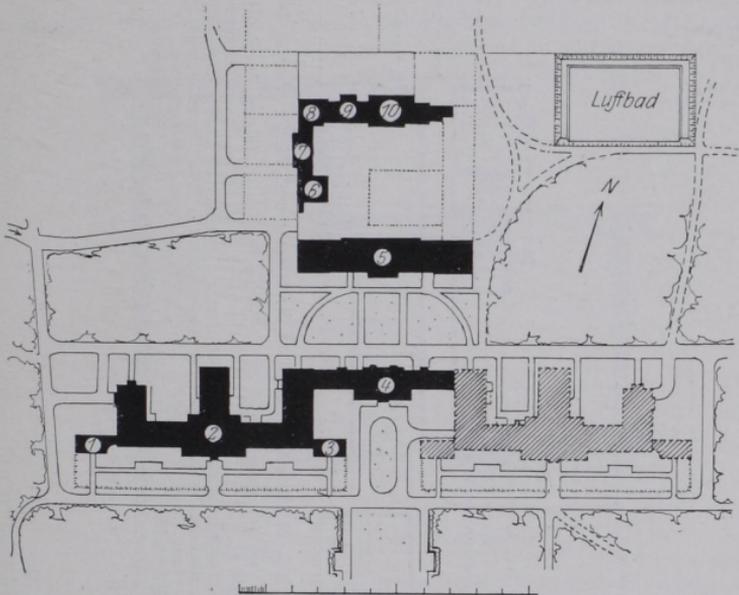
Lageplan des Tuberkulosekrankenhauses Hohenkrug bei Stettin. 1 u. 3 Liegehalle. 2 Krankenhaus. 4 Verwaltungsgebäude. 5 Wirtschaftsgebäude. 6 Pfortnerhaus. 7 Stallgebäude. 8 Maschinistenwohnhaus. 9 Werkstatt. 10 Kesselhaus.
